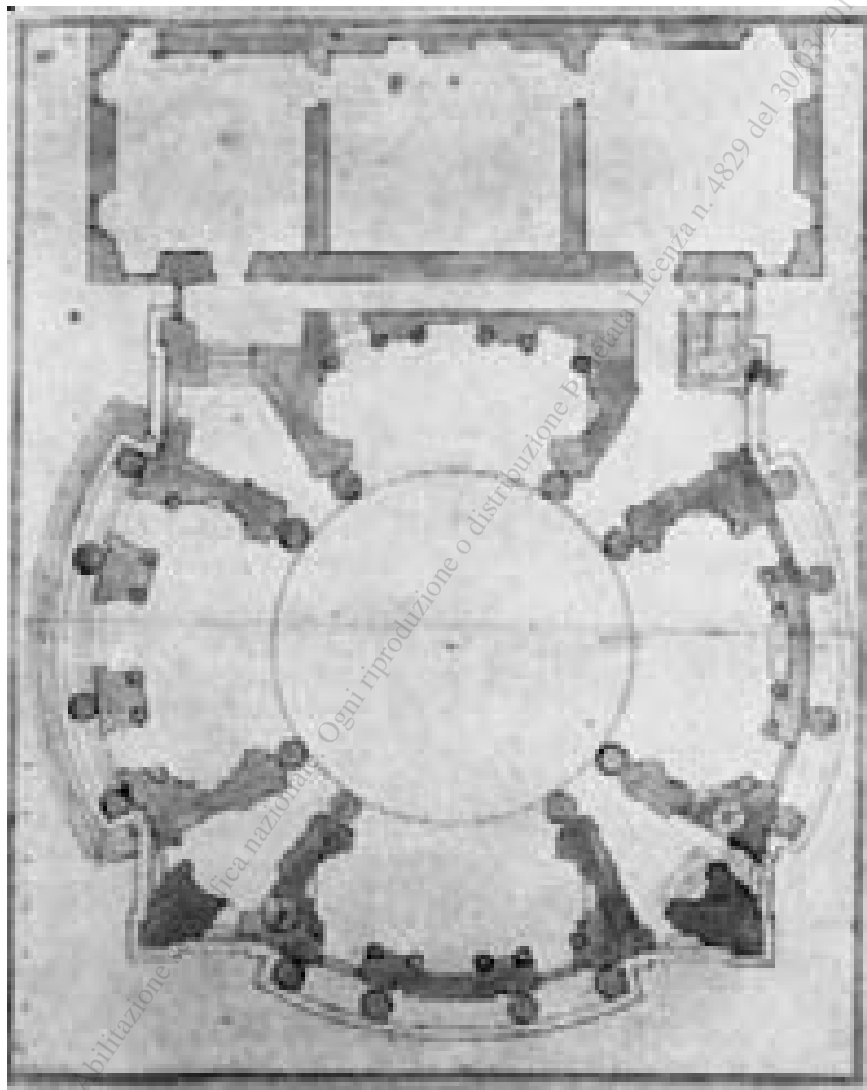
Progetto per chiesa a pianta centrale (Ss. Luca e Martina?): planimetria (copia di D. Martinelli: Milano, Collezione Bertarelli, Martinelli, I, f.1)
